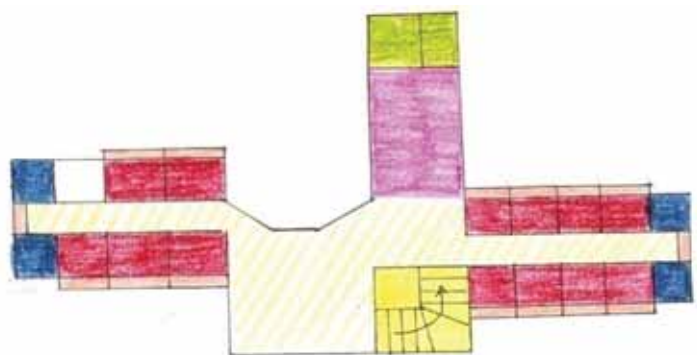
Planta do pavimento térreo do novo bloco da USP. Fonte: FERRO, 2010.
